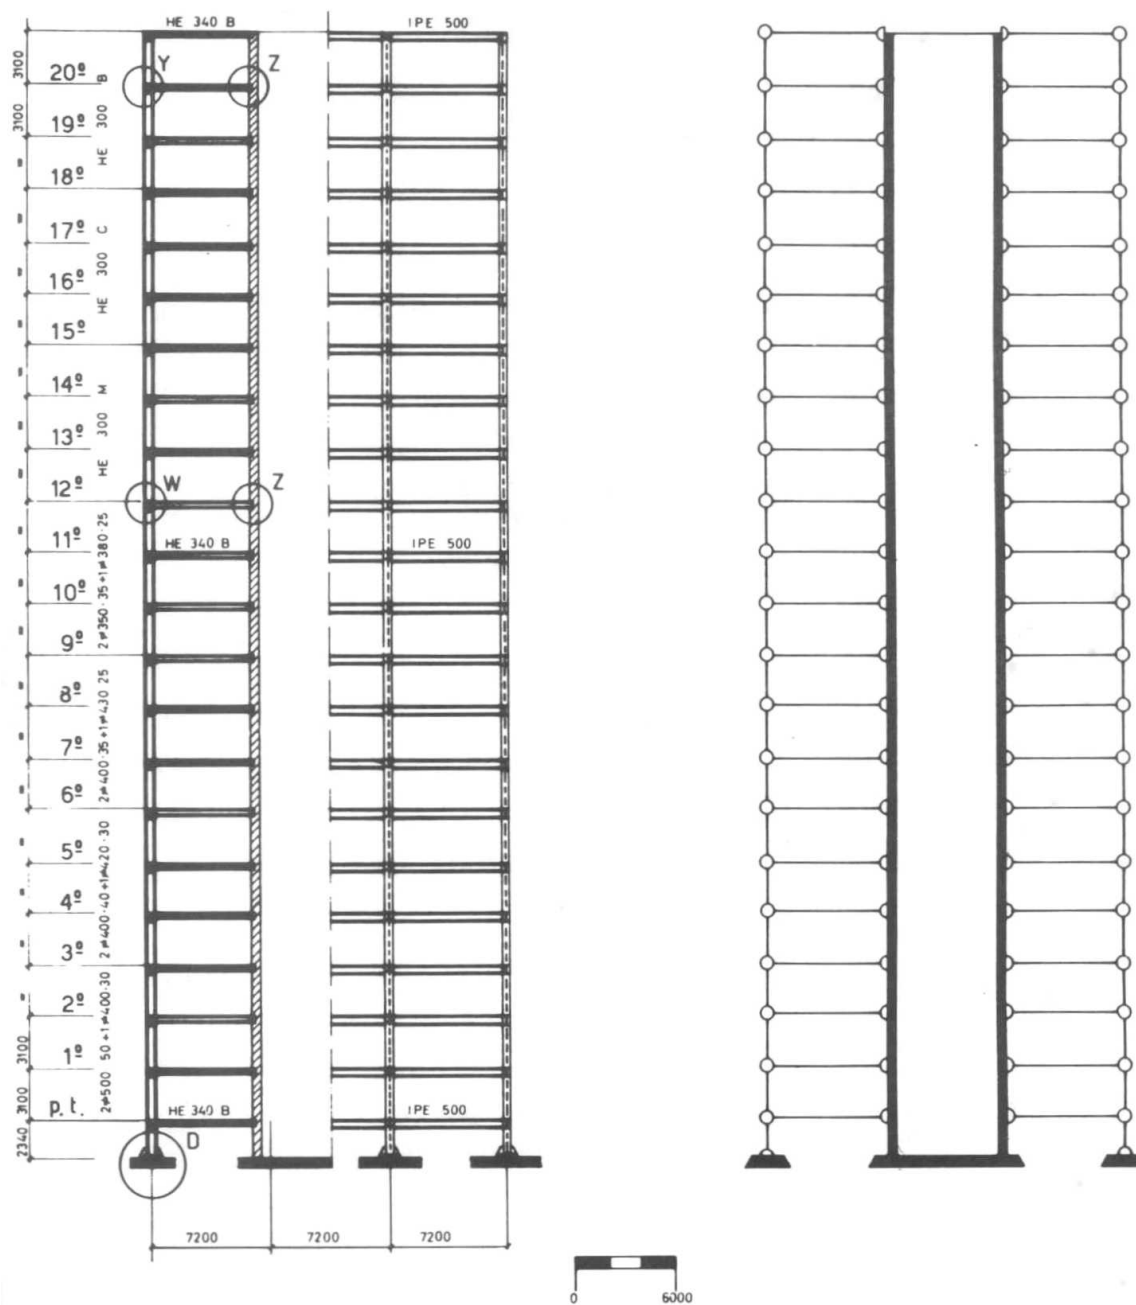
(a) Sezione X-X; (b) Schema strutturale.
